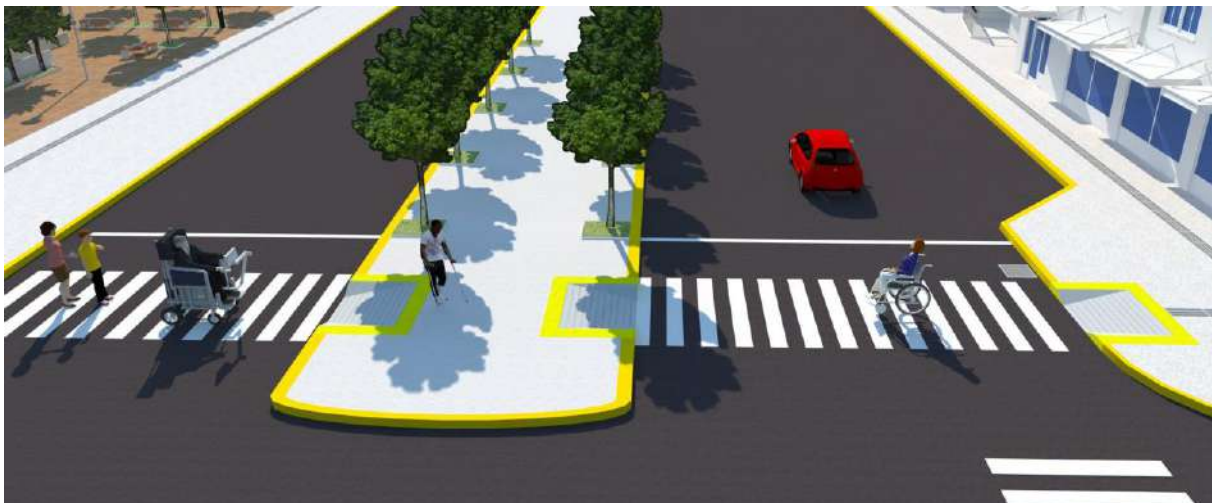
Detalle de calzadas y parterre central en donde el desnivel existente entre estas se salva mediante vados
